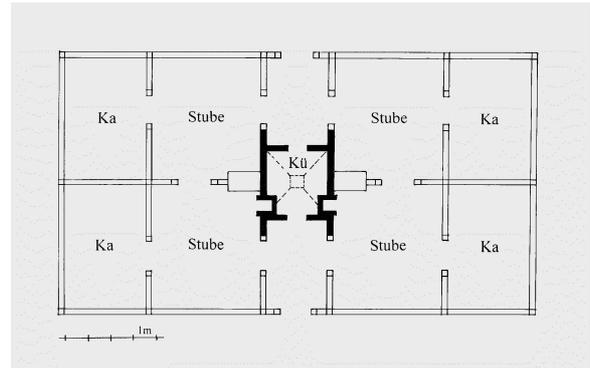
Grundriss-Rekonstruktion eines Großkolonistenhauses für die königlichen Kolonien
